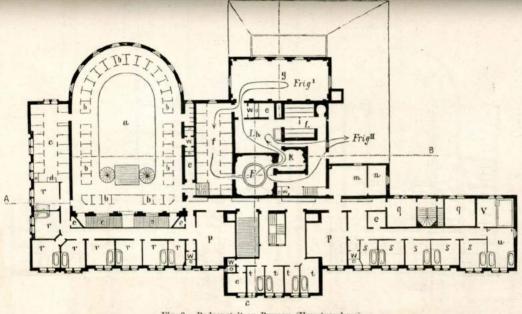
Badeanstalt zu Bremen (Erdgeschoss).
